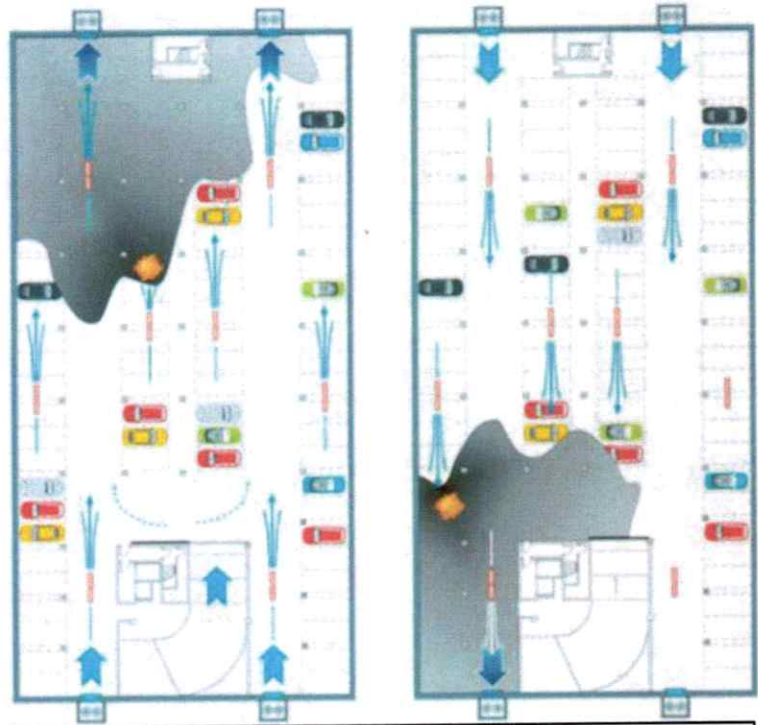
Schéma du principe de la ventilation de poussée.
